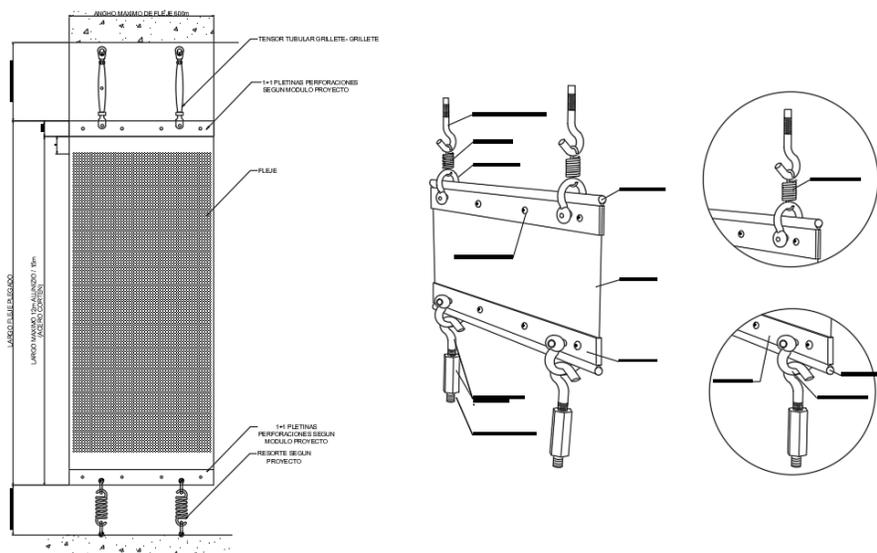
/Hunter Douglas/ Producto fachadas ventiladas Stripscreen.
